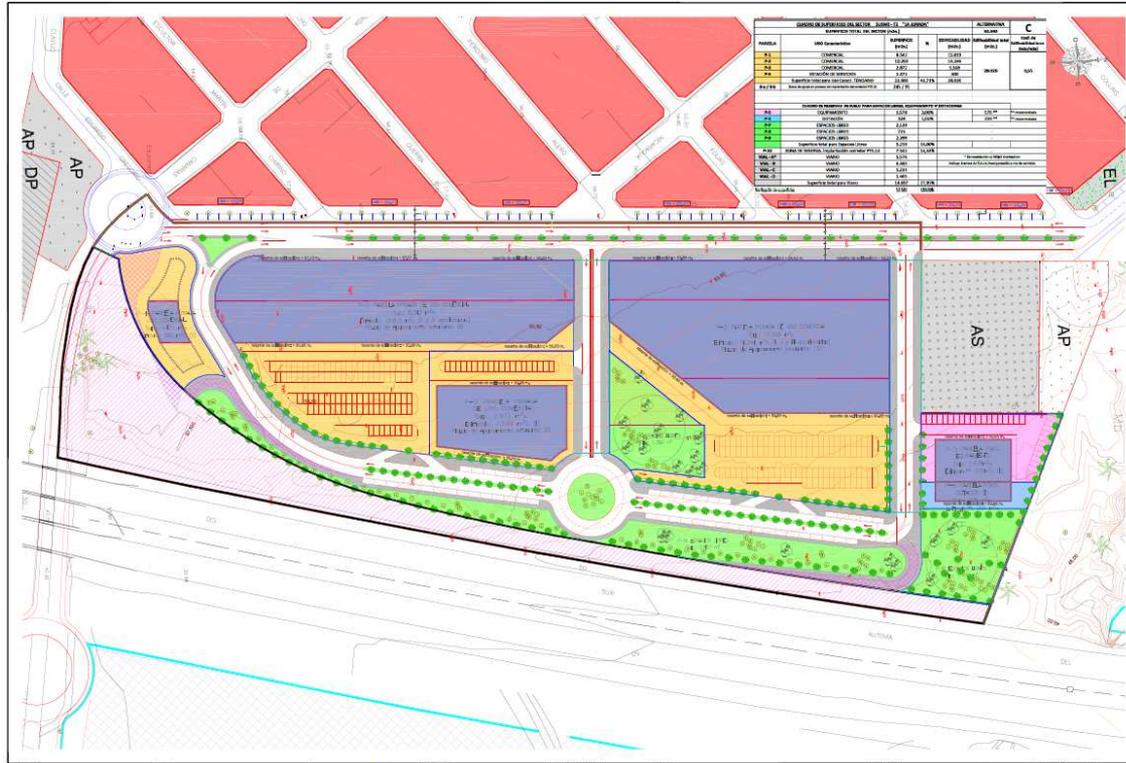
Plano General Alternativa C. Elaboración propia.
